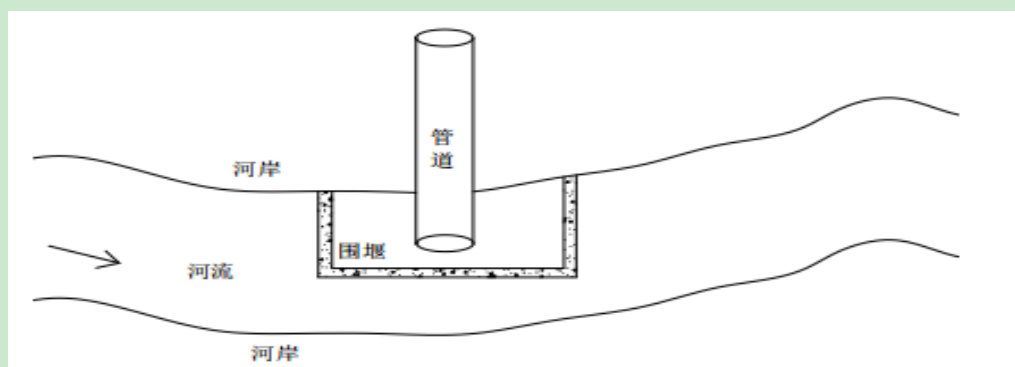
围堰导流开挖管沟法施工断面示意图
